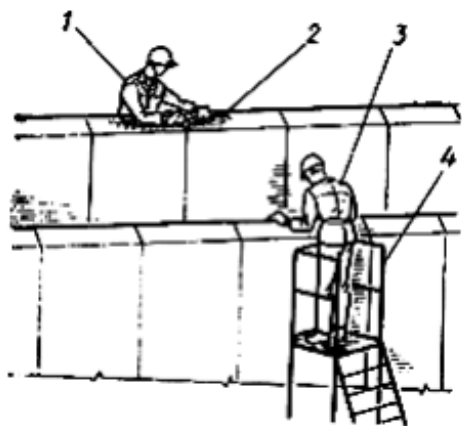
Схема подготовки места установки лестничной площадки
